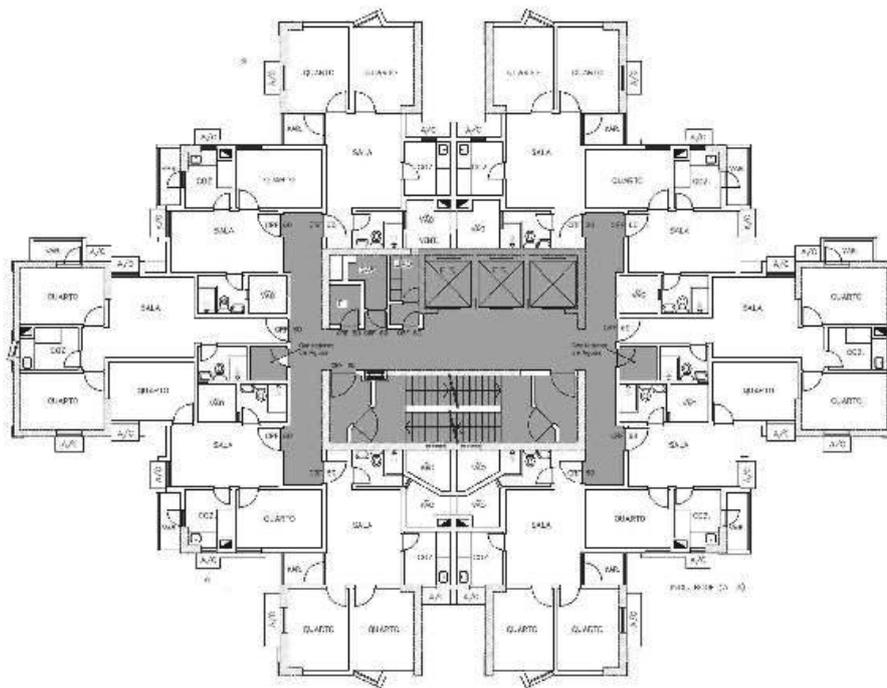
Planta de andar típico – Zonas comuns. Esc. aprox. 1:25
